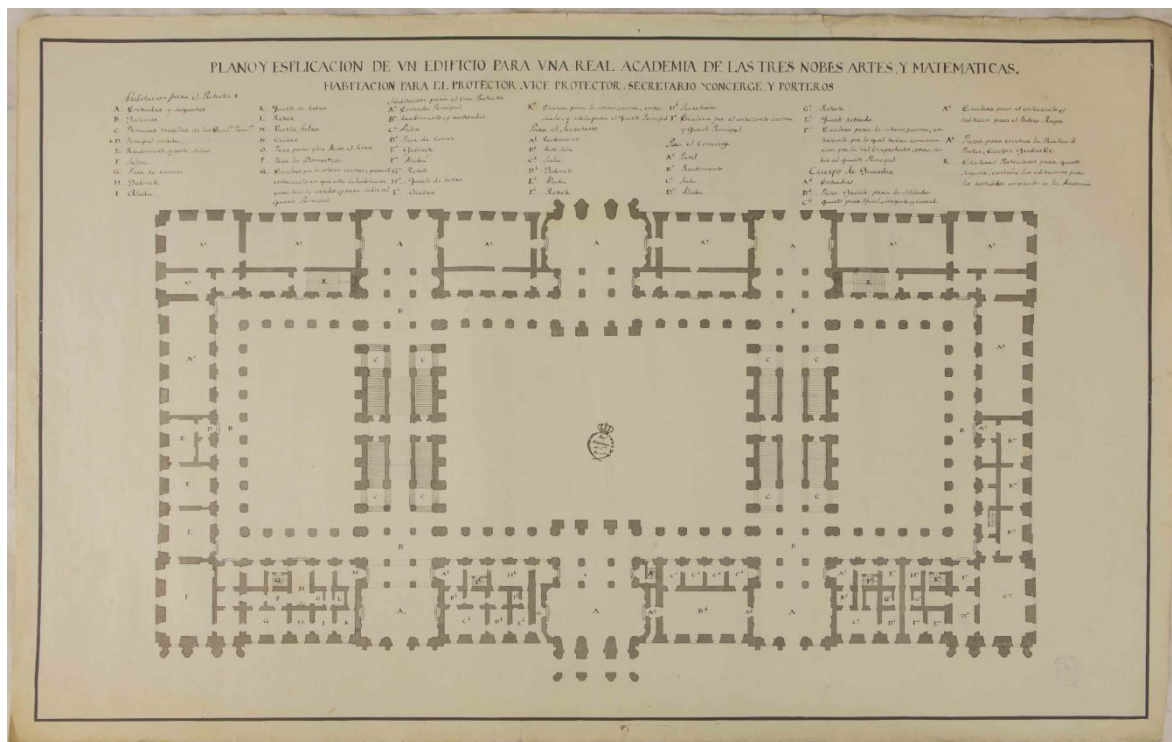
Dibujo A-257: Planta baja, Archivo R.A.B.A.S.F.
